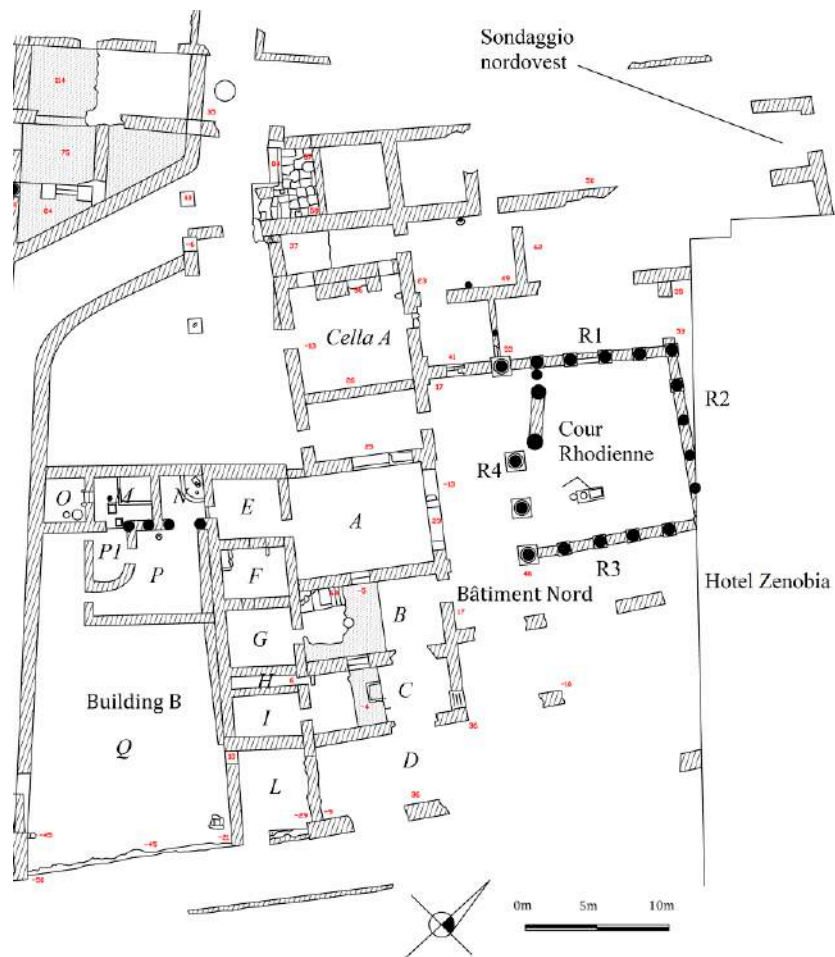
Pianta del *Bâtiment Nord* e *Building B* (disegno dell’Autore, basato su piante inedite presso il FAPC).
